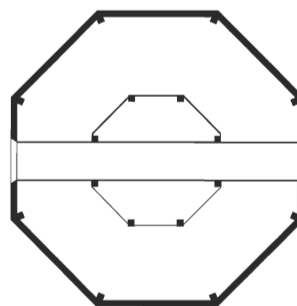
Fig. IV - VUE EN PLAN, À LA HAUTEUR DES COMBLES
